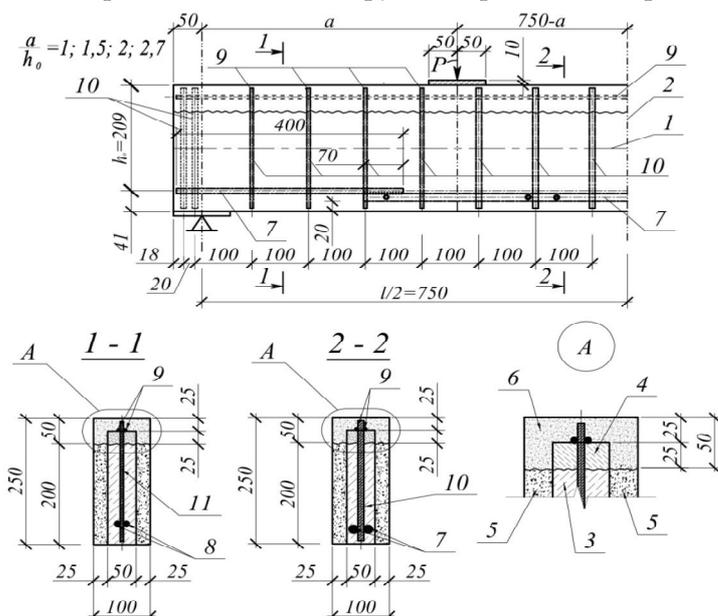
Конструкции опытных образцов: 1,2 - продольная и вертикальная оси образца; 3 - основной бетон (класс В20); 4 - бетон усиления (класс В30); 5,6 - коррозионно-поврежденные основной бетон (класс В12,5) и бетон усиления (класс В20); 7,8 - рабочая арматура в середине пролета (2Ø16 А400С) и в приопорной зоне (2Ø10 А400С); 9 - арматура в сжатой зоне (2Ø6 А240С); 10 - поперечные стержни (Ø6, Ø10 А240С)
